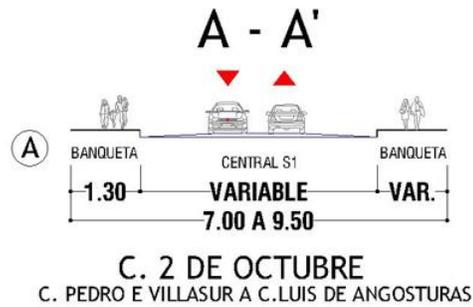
Sección vial actual e imagen de la C. 2 de Octubre.
